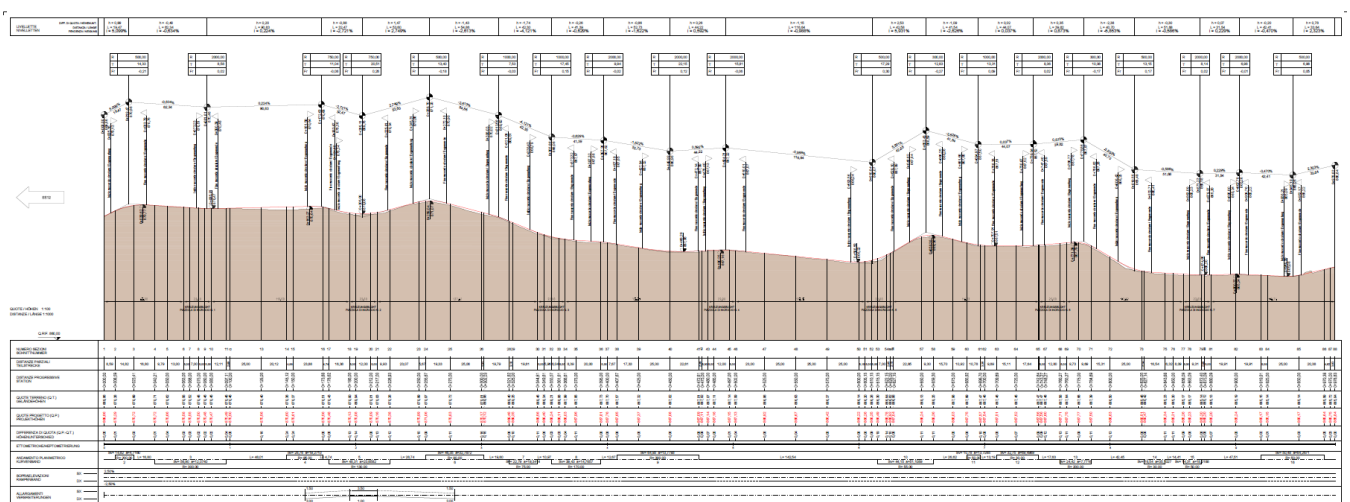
Längsschnitt Zufahrtstrasse Baustelle Genauen 2
